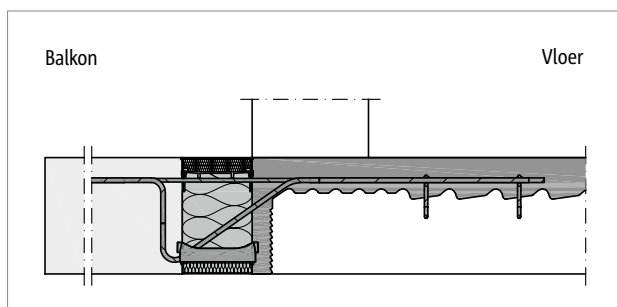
Schöck IDock®: Vlak uitgelijnde balkonaansluiting, hier met Schöck Isokorf® XT type K-E.
